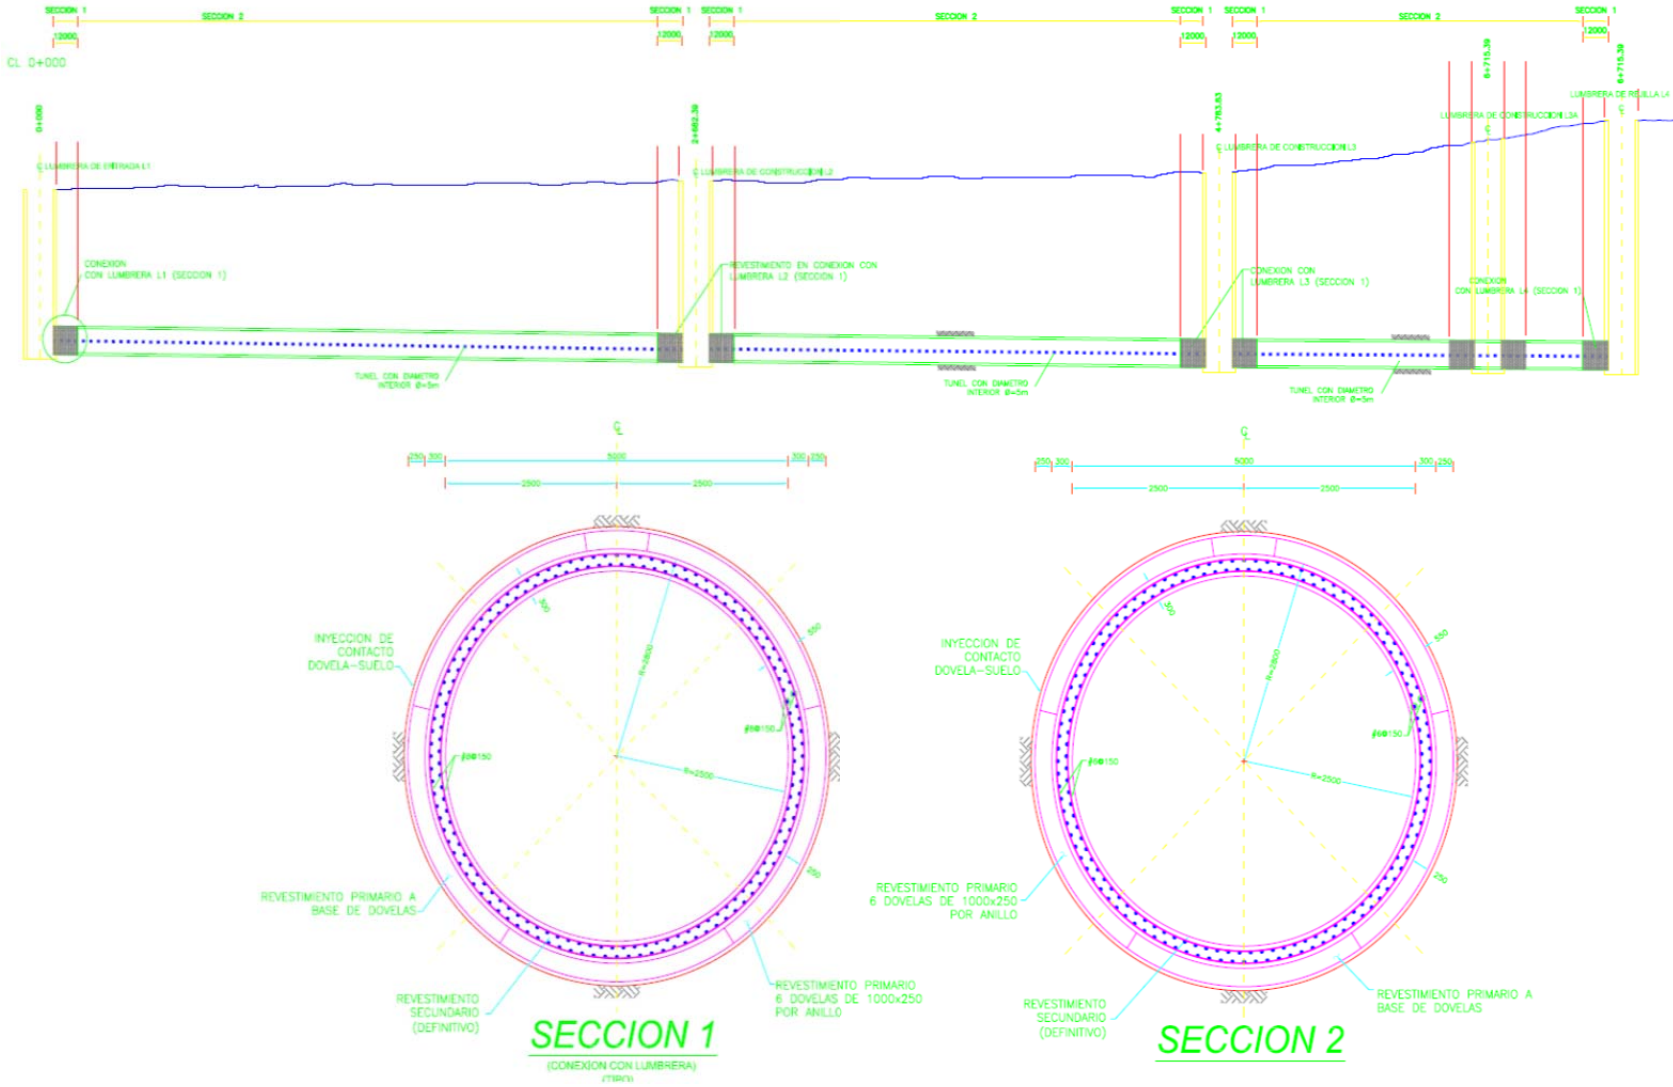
Secciones para el armado del revestimiento definitivo
